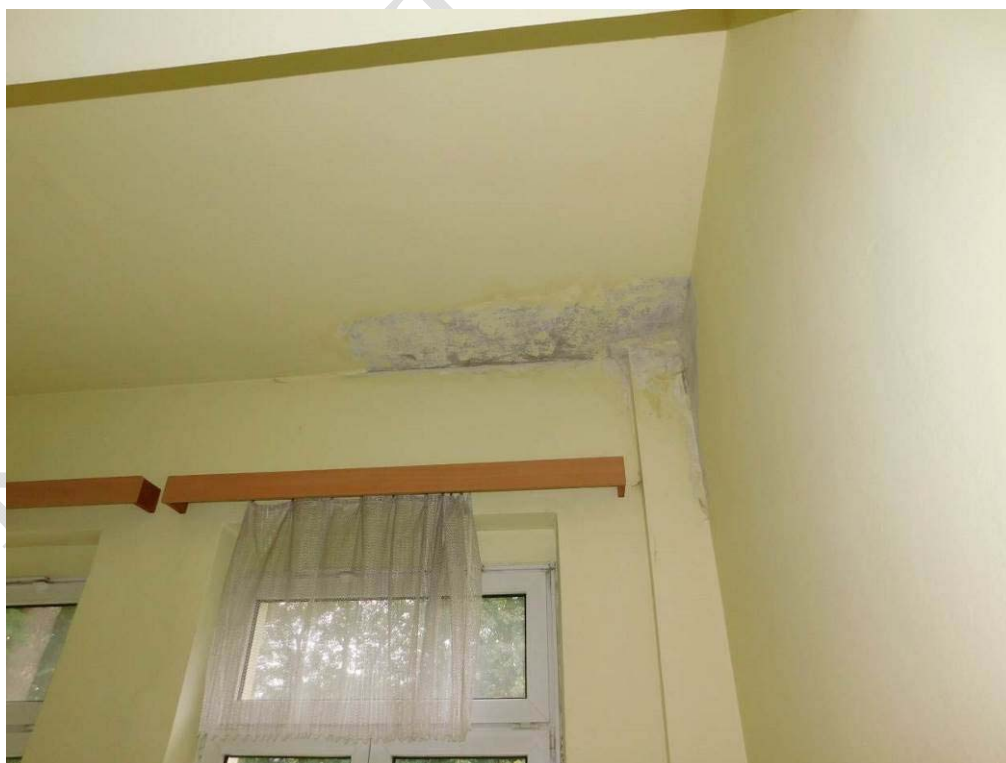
Viditelné lokální průsaky východní části objektu (úroveň 3.NP)
